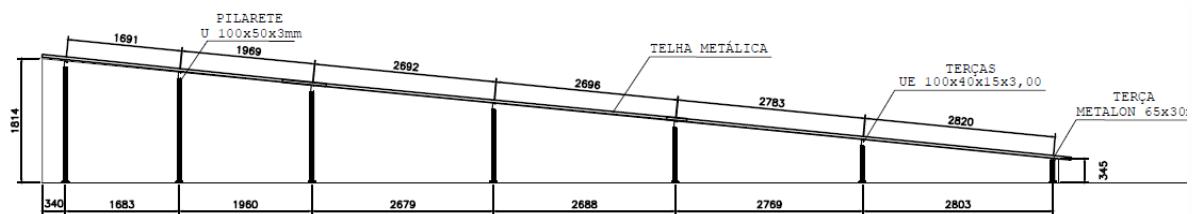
Corte esquemático representando a estrutura metálica da cobertura existente.
